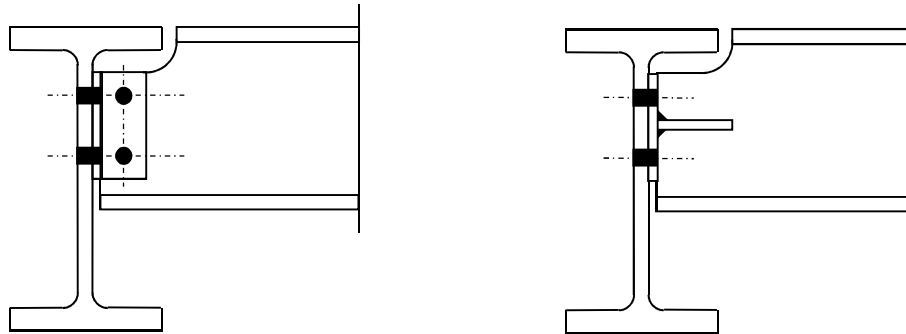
Exemples d'assemblages articulés sollicités par un effort tranchant
